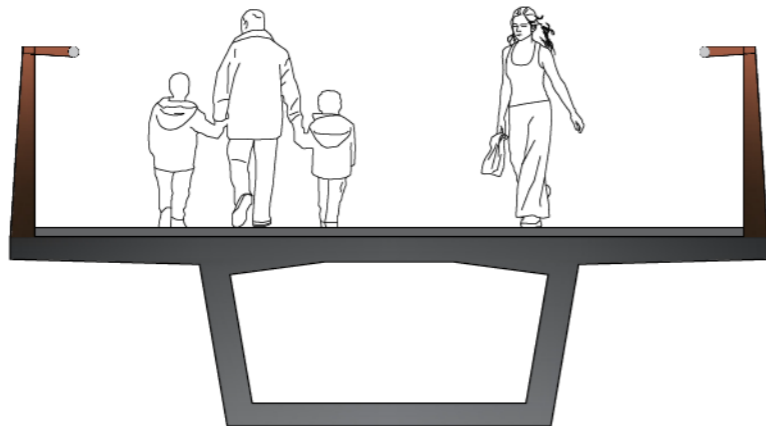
Tablero en cajón para solución viga. Fuente: Elaboración Propia (AutoCAD)
